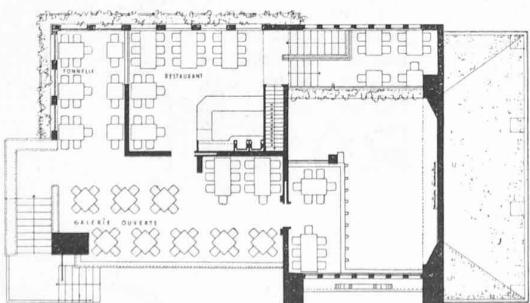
La « Cave vaudoise ». Plan de l'étage.
